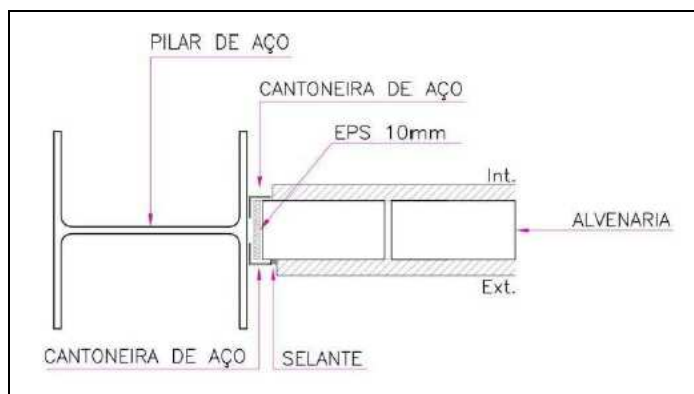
Detalhe demonstrativo 02: execução das paredes em alvenaria desvinculada.
